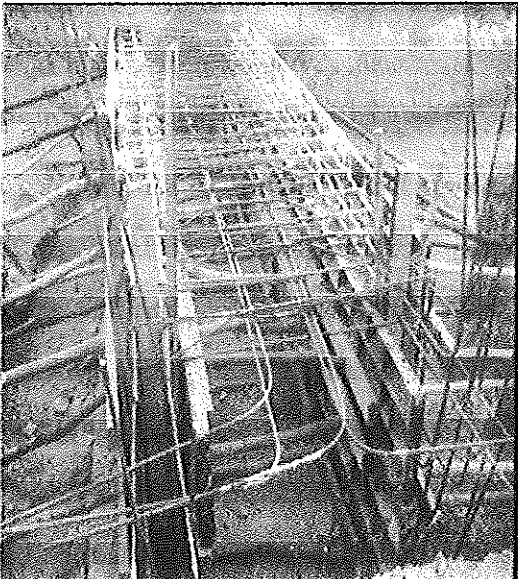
ELABORACIÓN DE OBRAS DE ARTE
